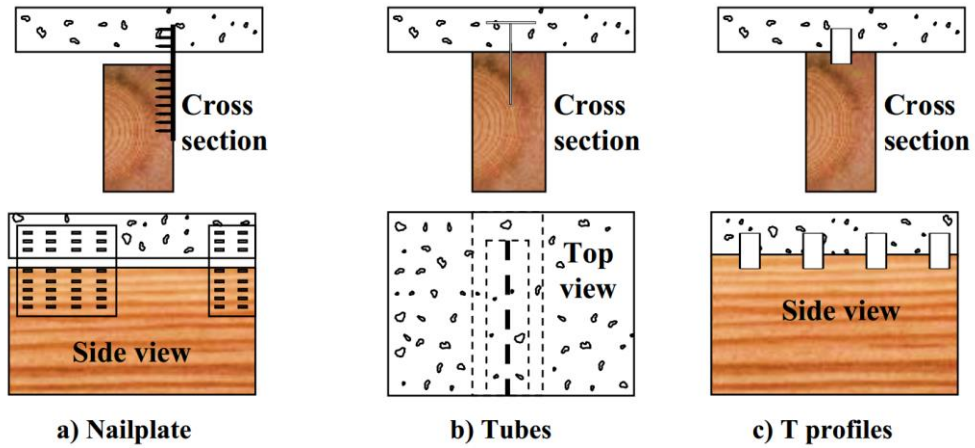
Plaque à clouer, tubes et profilés en T collés au bois [13].
